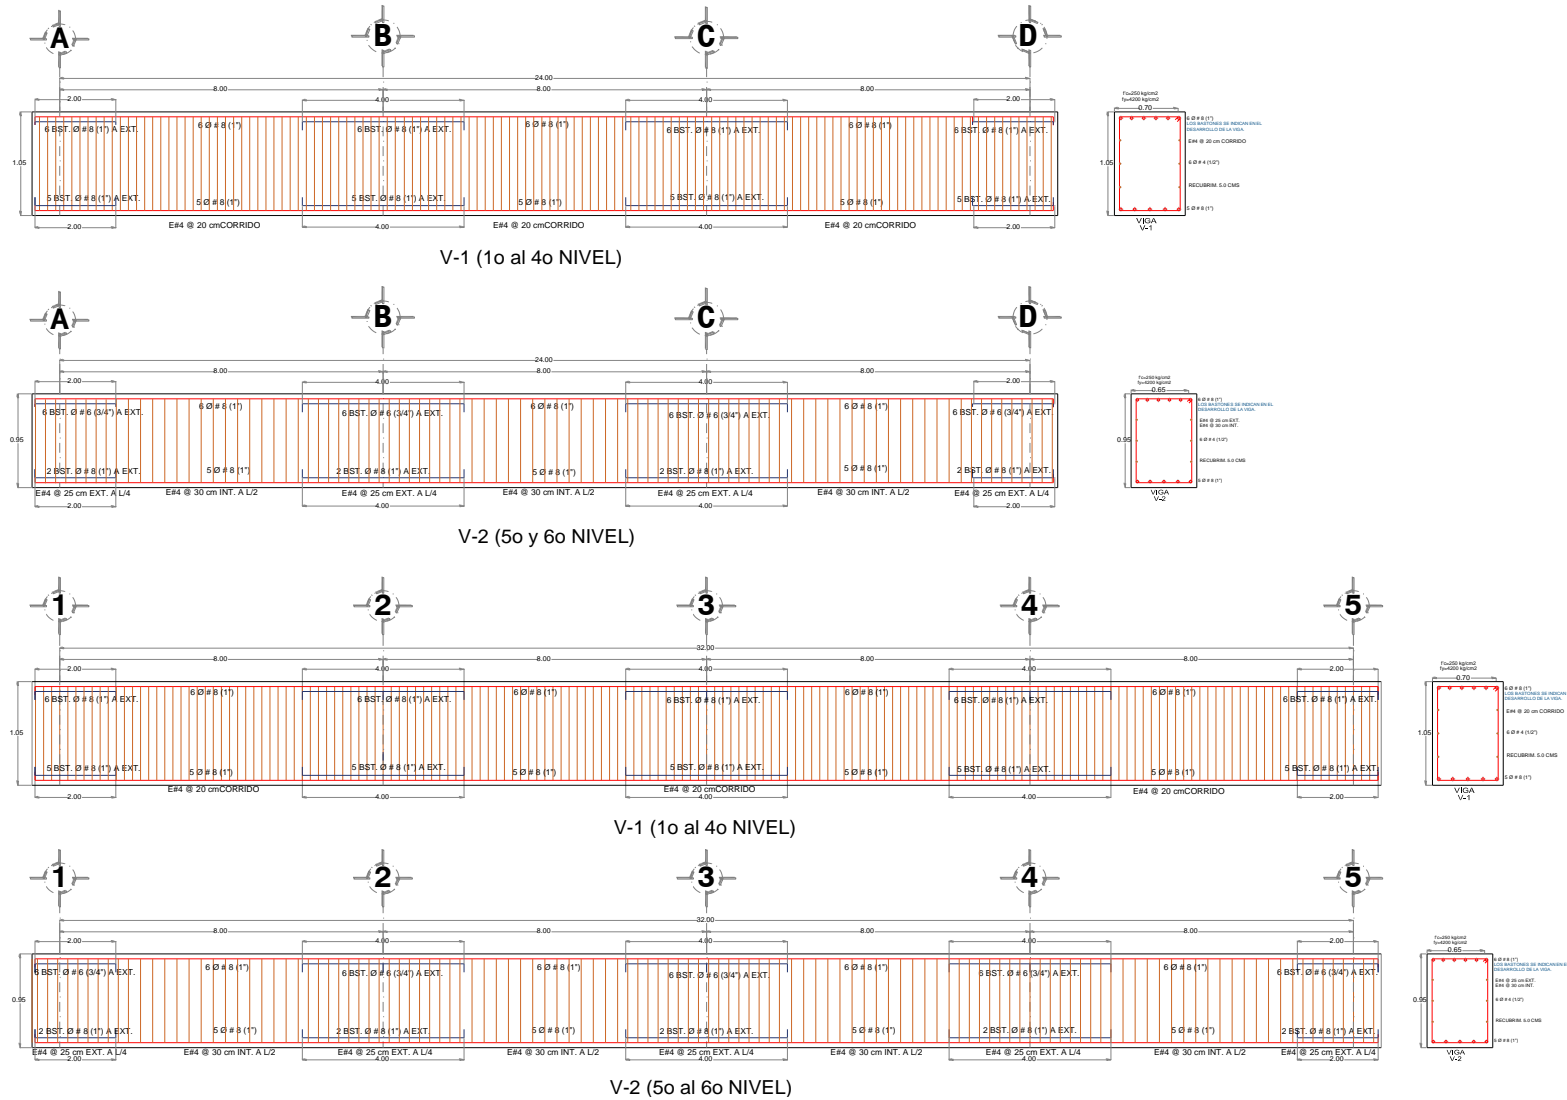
Detallado de armado de vigas de edificio de 9 niveles con base a la hipótesis de las NTCC-17.
